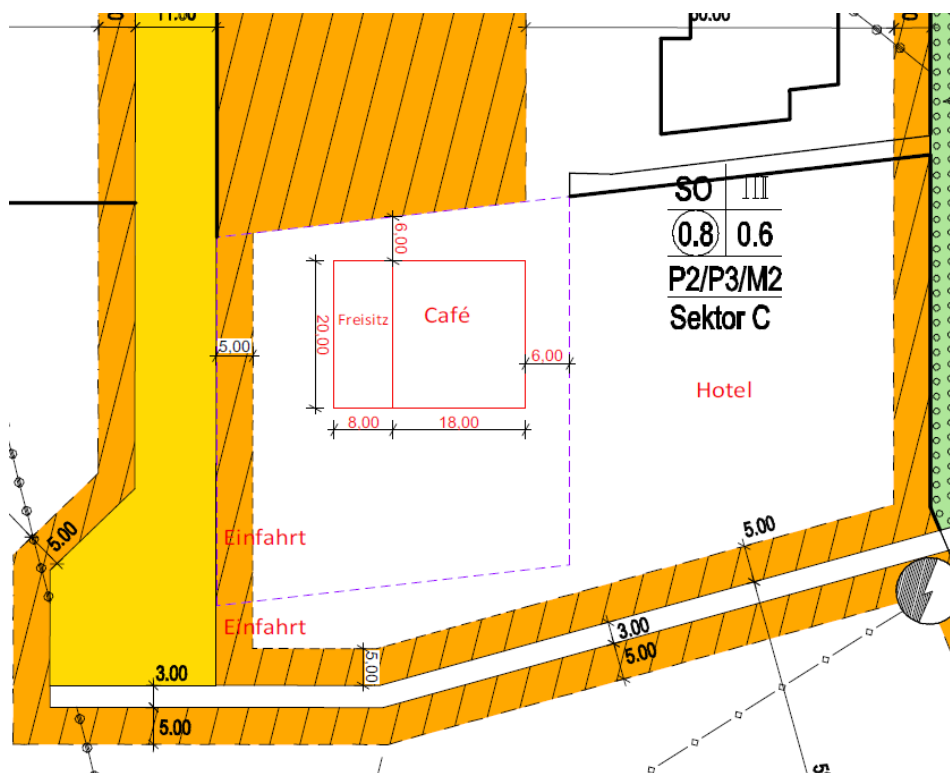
Lageplan Neubau Café am Krankenhaus. Quelle: Architektenbüro Freienberg, Bad Gandesheim, ohne Maßstab
